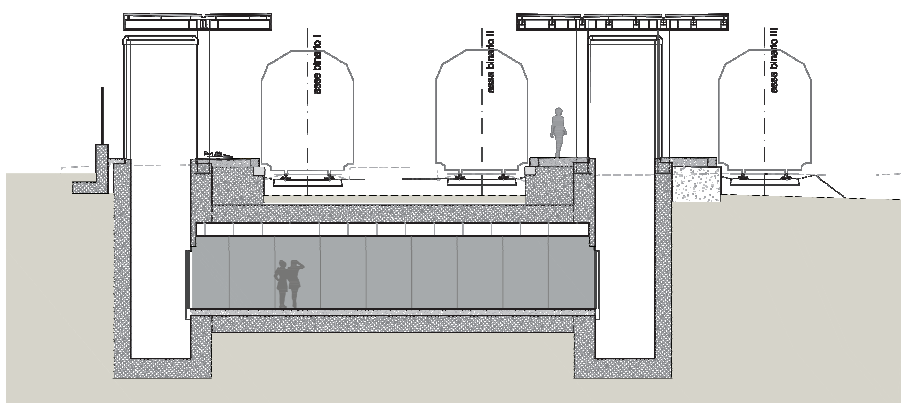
Sezione in asse al sottopasso, trasversale alle pensiline
